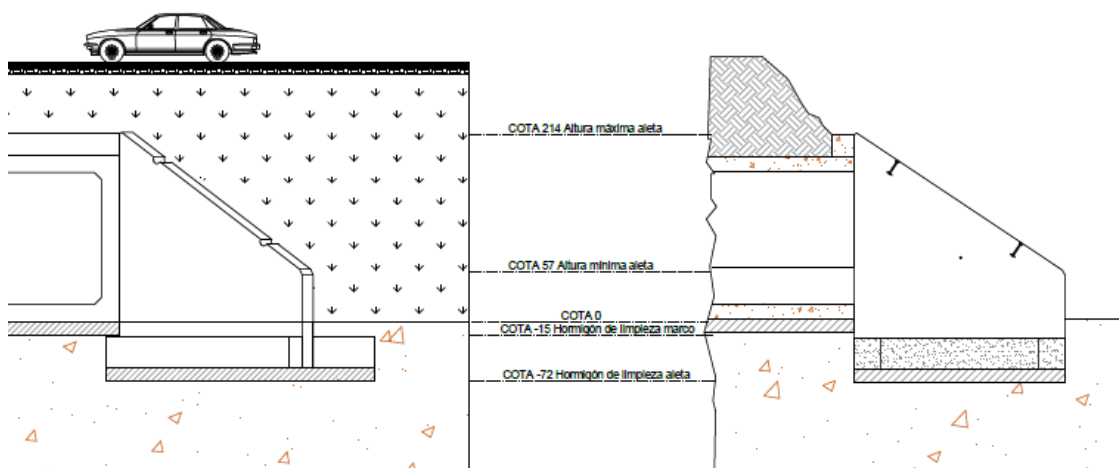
Tipología de cajón hincado utilizado para mantener en servicio los caminos existentes que quedarían inservibles por la construcción de la nueva vía.
